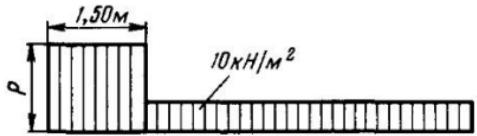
Вертикальная нагрузка на призме обрушения от гусеничных и колесных кранов
